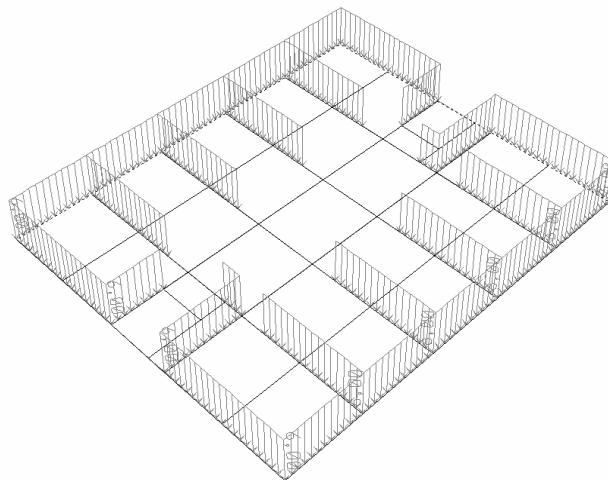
Carregamento de peso próprio das paredes sobre as vigas.
